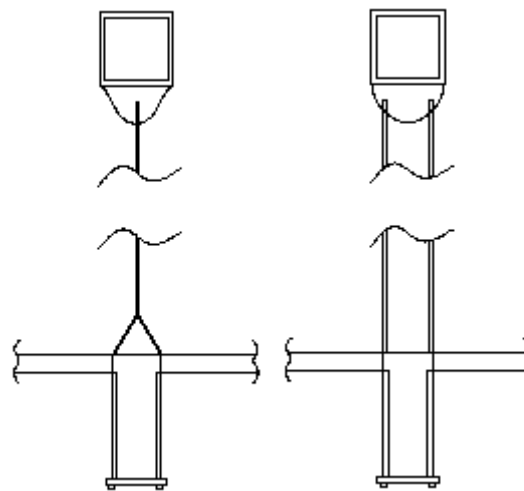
10. Conexión entre péndolas y arco-tablero para obra de refuerzo.
